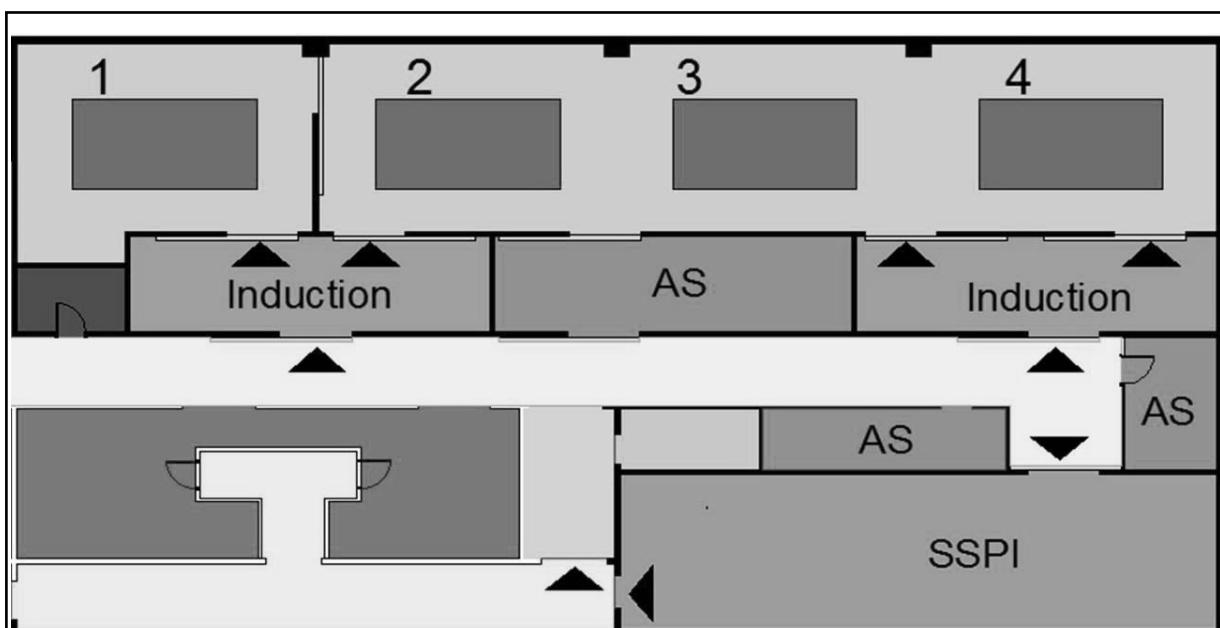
Plan du hall opératoire du CHU de Grenoble.
